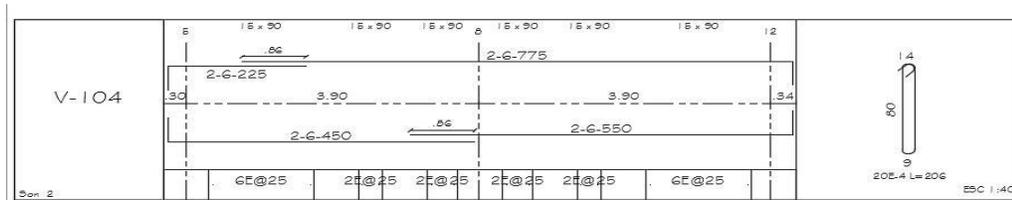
Despiece de viga de cimentación sentido transversal.
